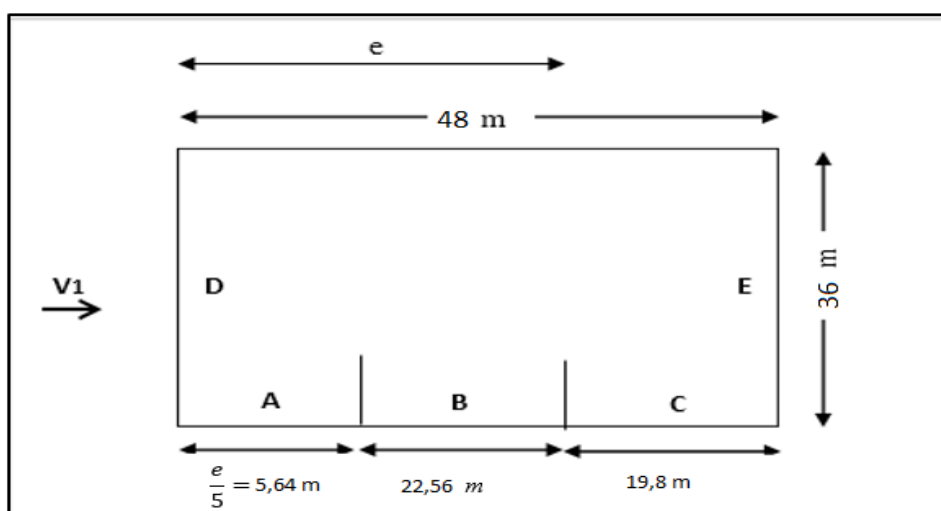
Vue en plan des zones de pression sur les parois verticales sens V1
